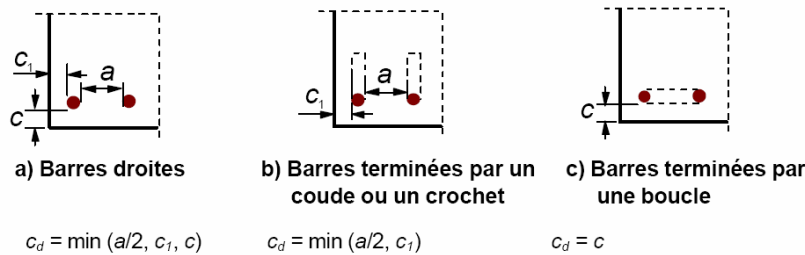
Valeurs de c_d pour les poutres et les dalles
